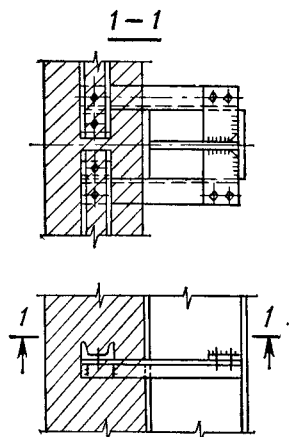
Пример крепления ветровых ригелей самонесущих стен к стойкам
